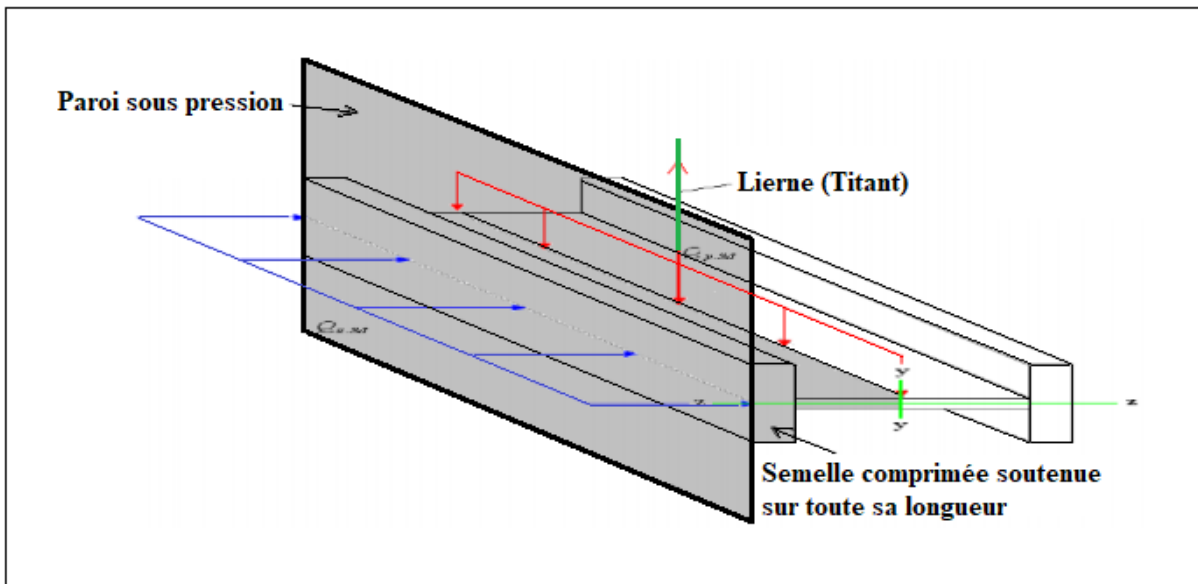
Semelle comprimée soutenue sur toute sa longueur.
